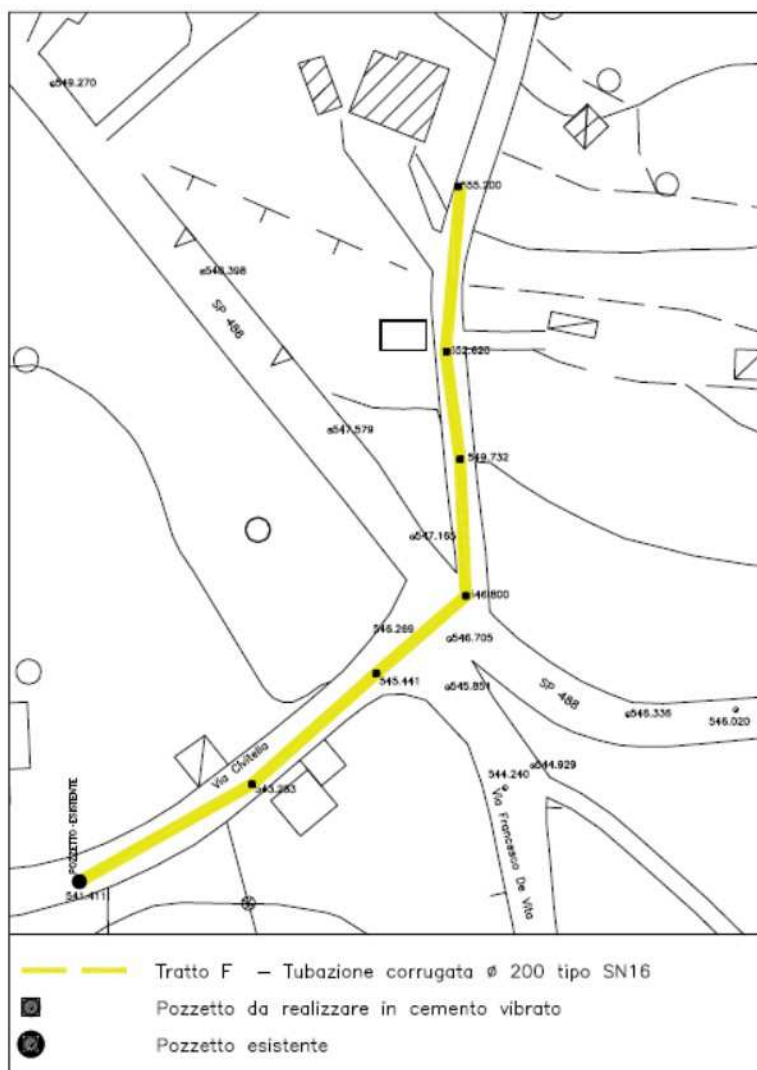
Planimetria di progetto di completamento e risanamento del collettore fognario Tratto F
